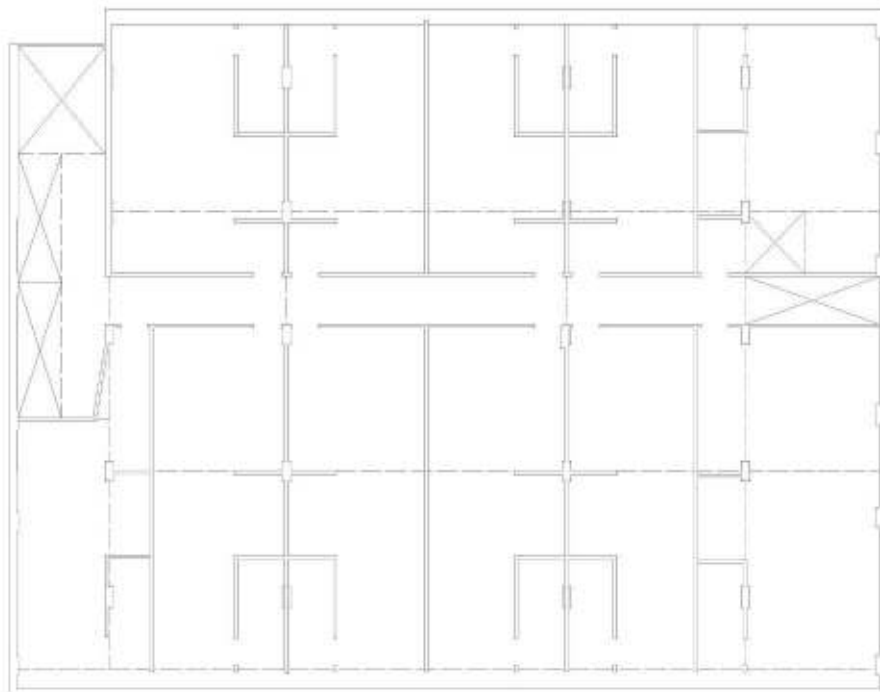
Planta baixa do 6. até o 10. pavimento (trabalho não publicado¹³)
